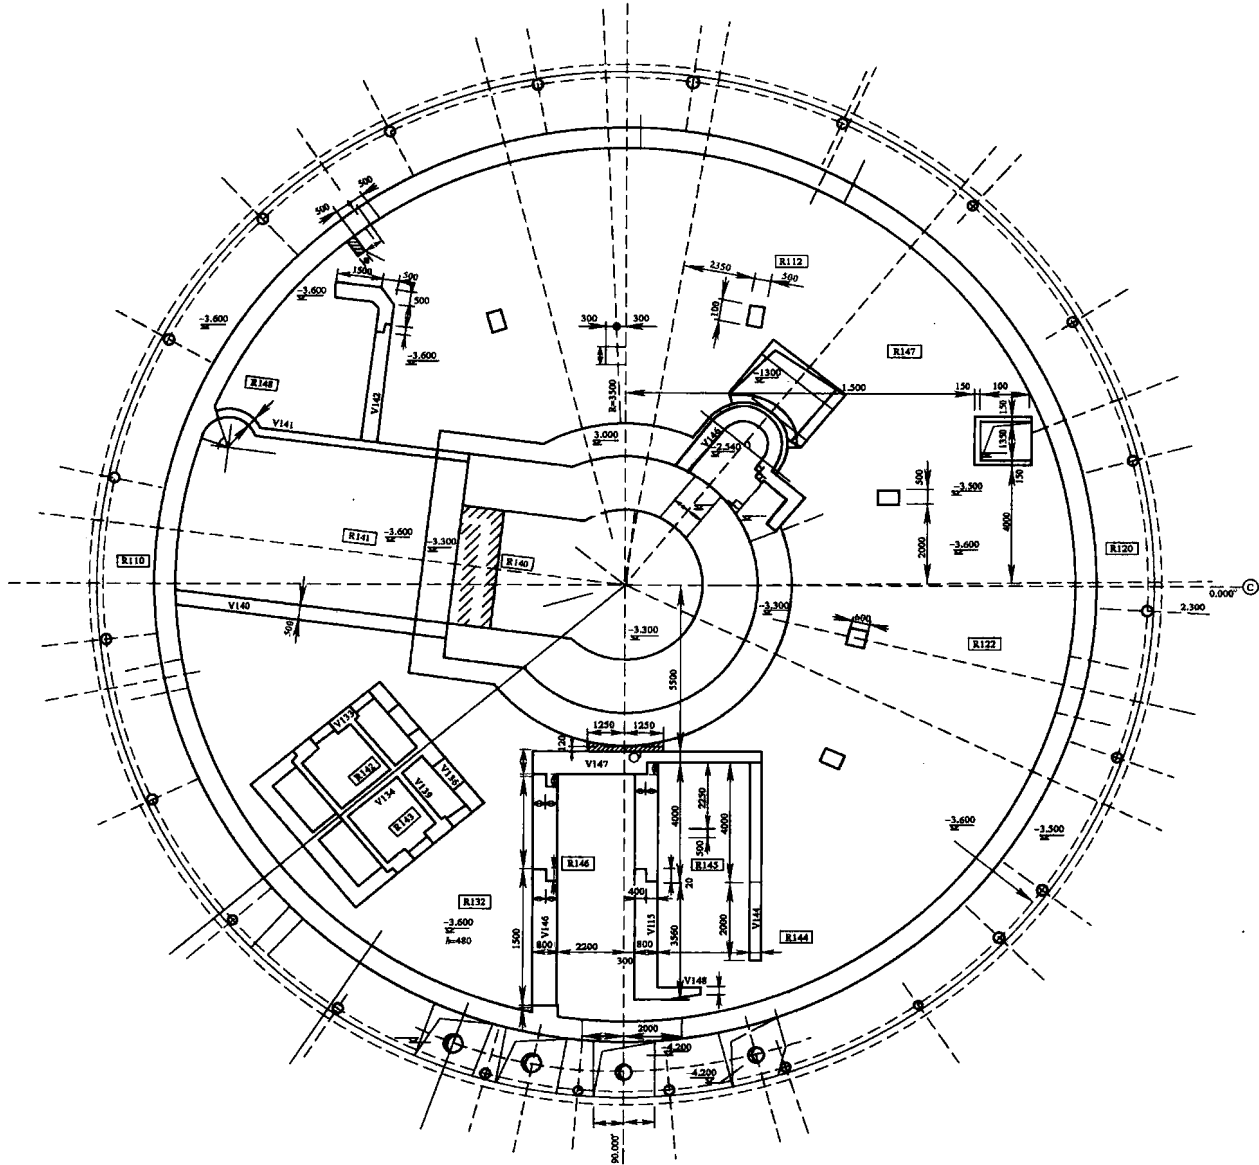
反应堆厂房内部结构—3.500m 平面图
